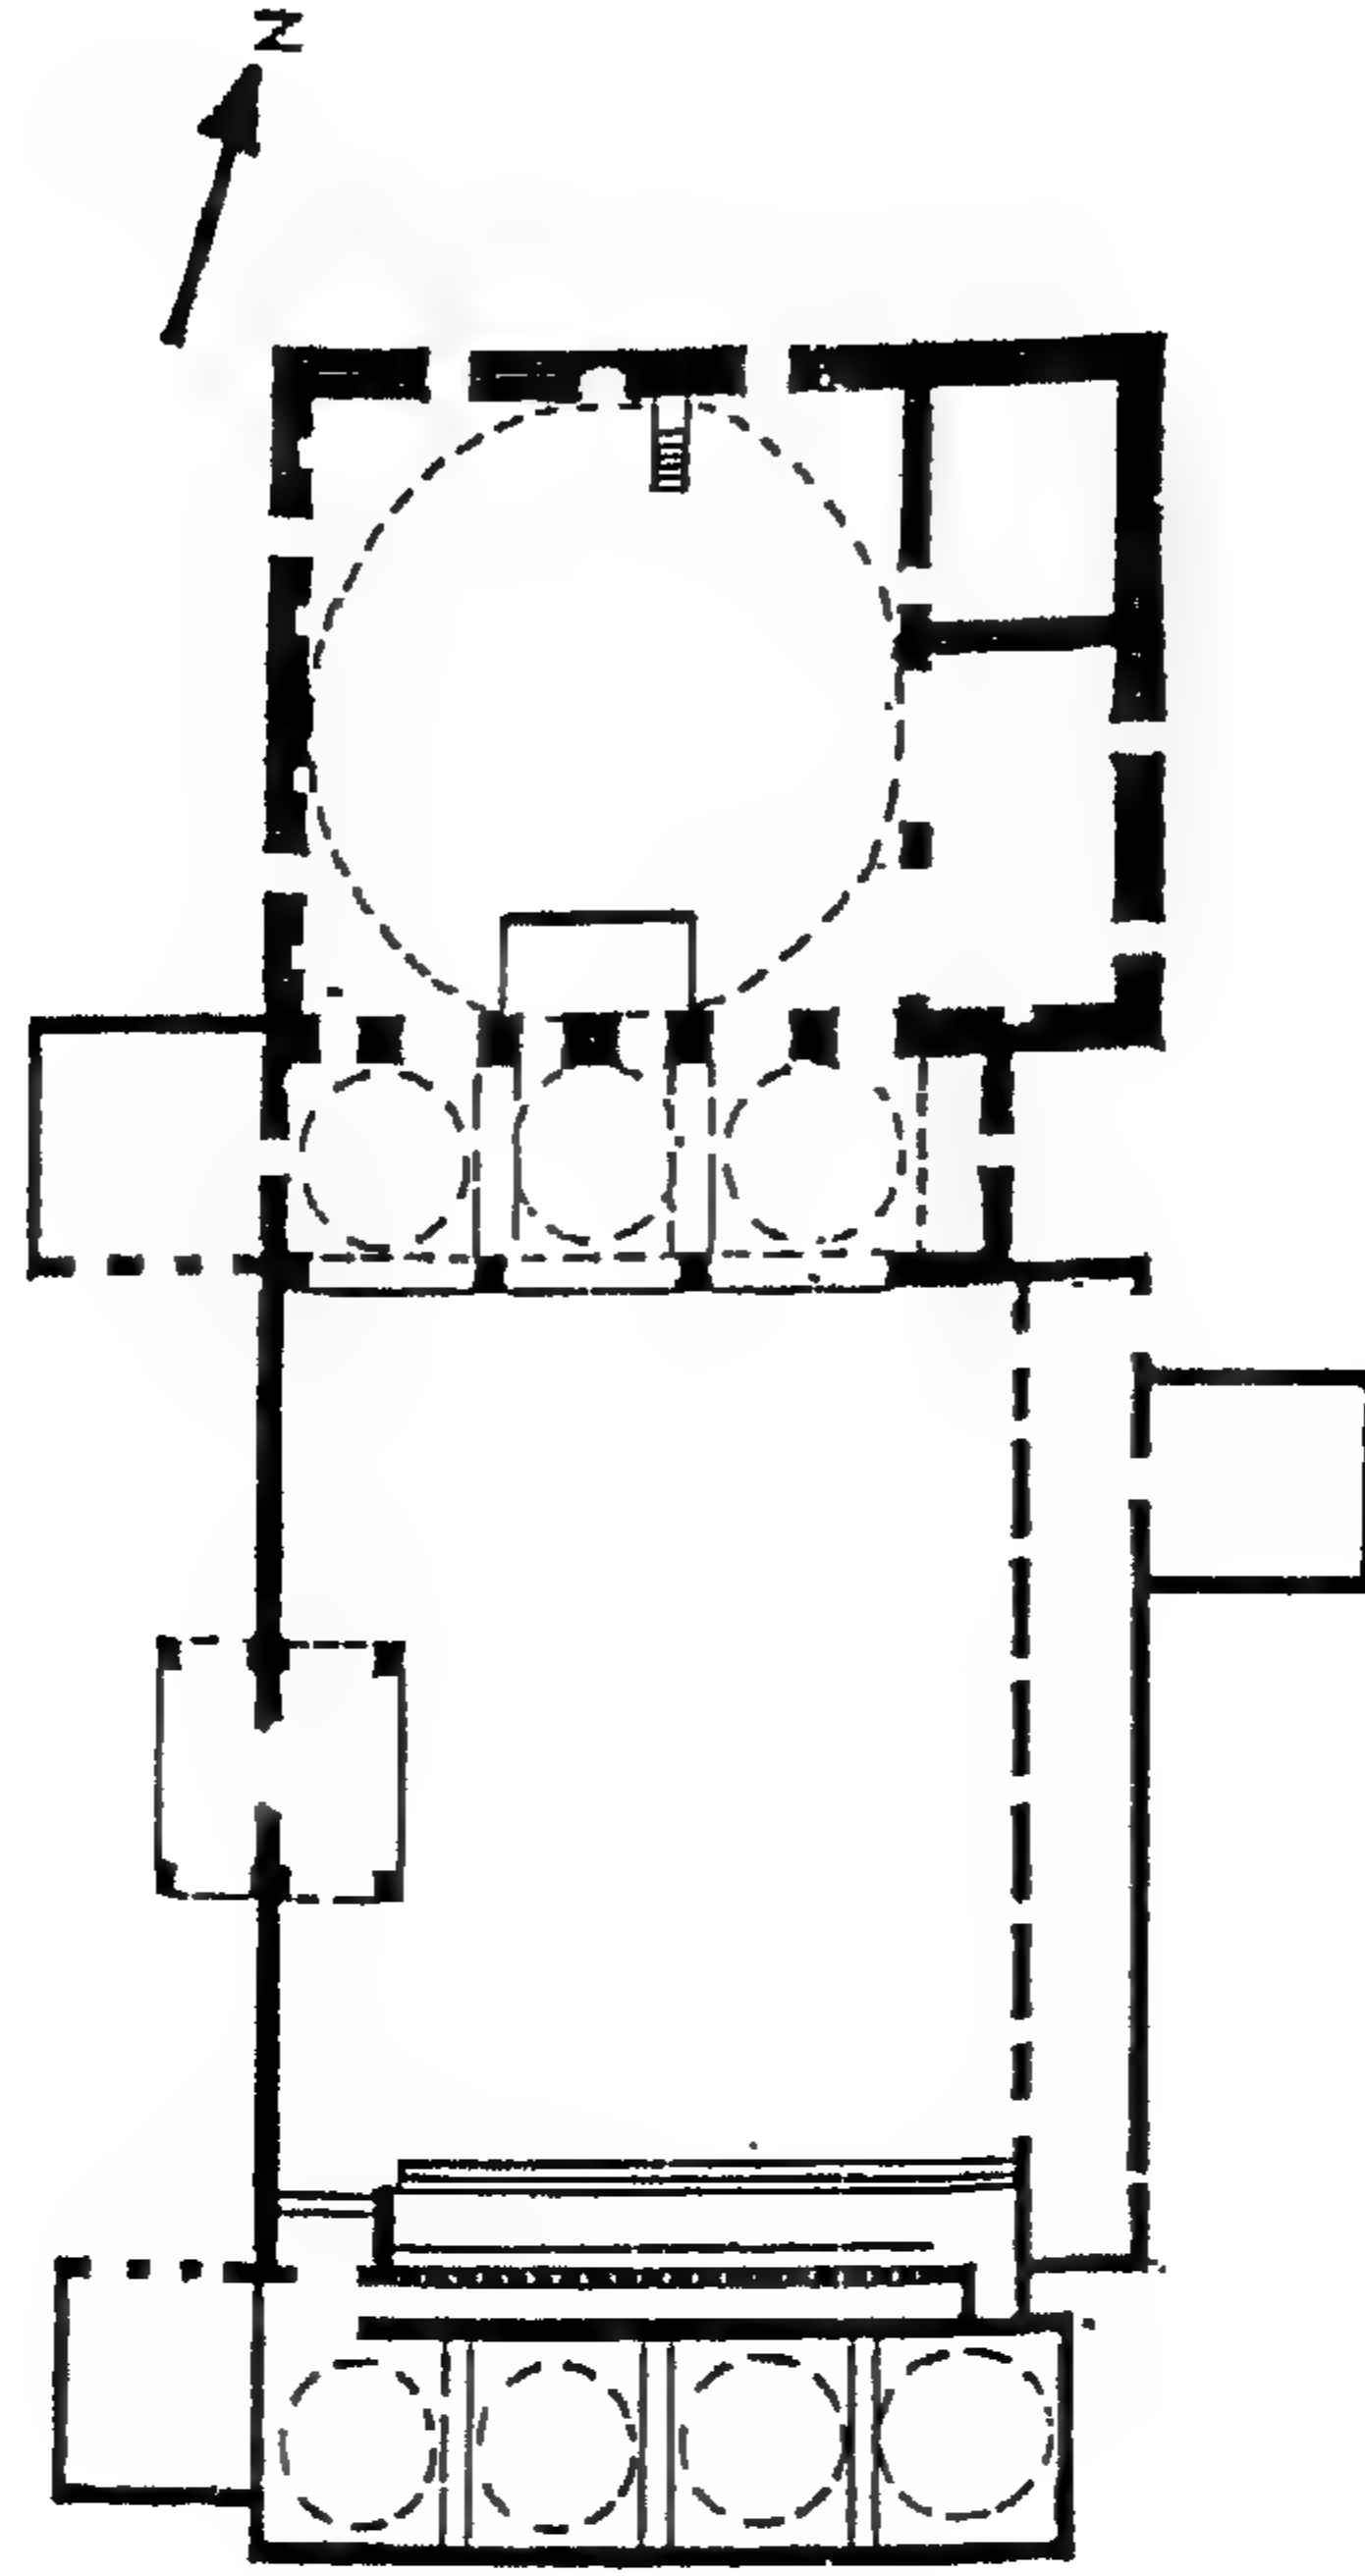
مسقط أفقي للجامع الكبير بصنعاء اليمن (عن : كريزول) .
